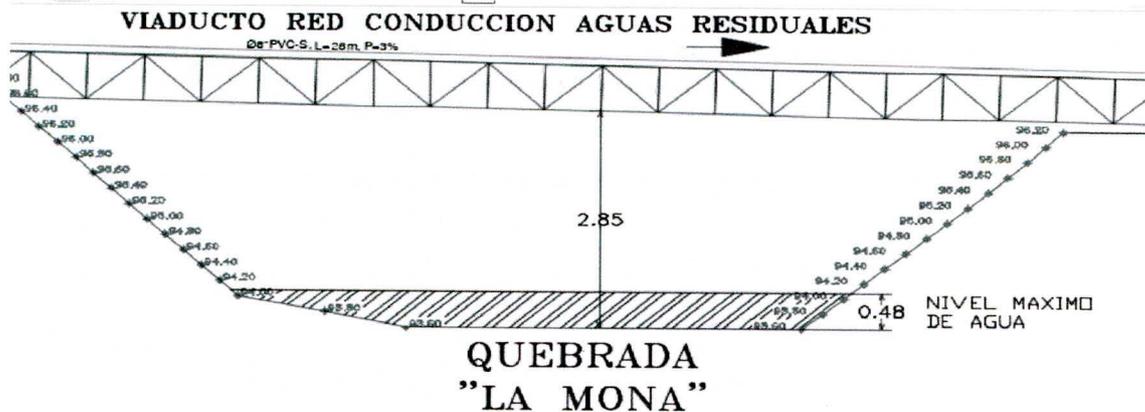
Sección transversal de la cercha tipo celosía que soportará la tubería y detalle del anclaje sobre las estructura en concreto a lado y lado del cauce
